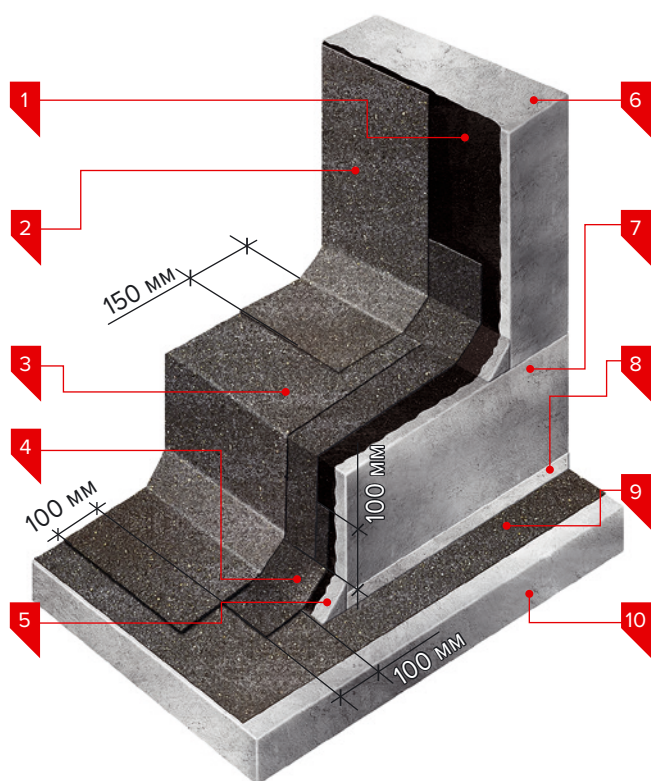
Укладка материала Техноэласт Фундамент ГИДРО со сплошной приклейкой к основанию:
